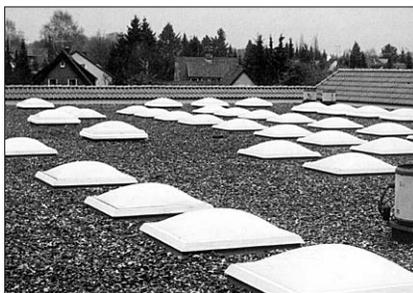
Кровля здания выполнена из материала Carisma CI с балластным креплением
